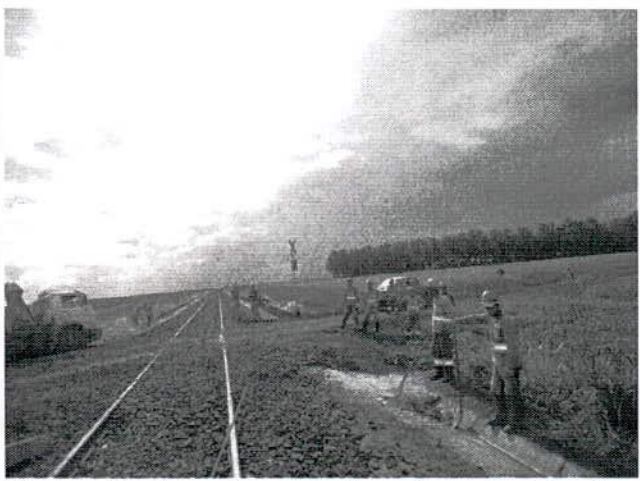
equipe trabalhando na instalação de placas de sinalização.
